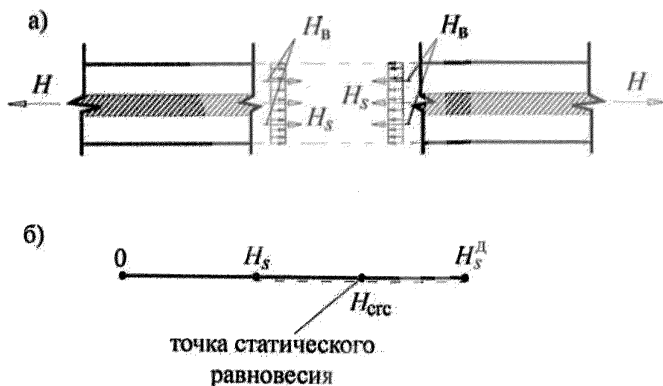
Схема статических (а) и динамических усилий (б) в железобетонном элементе в момент хрупкого разрушения бетона
